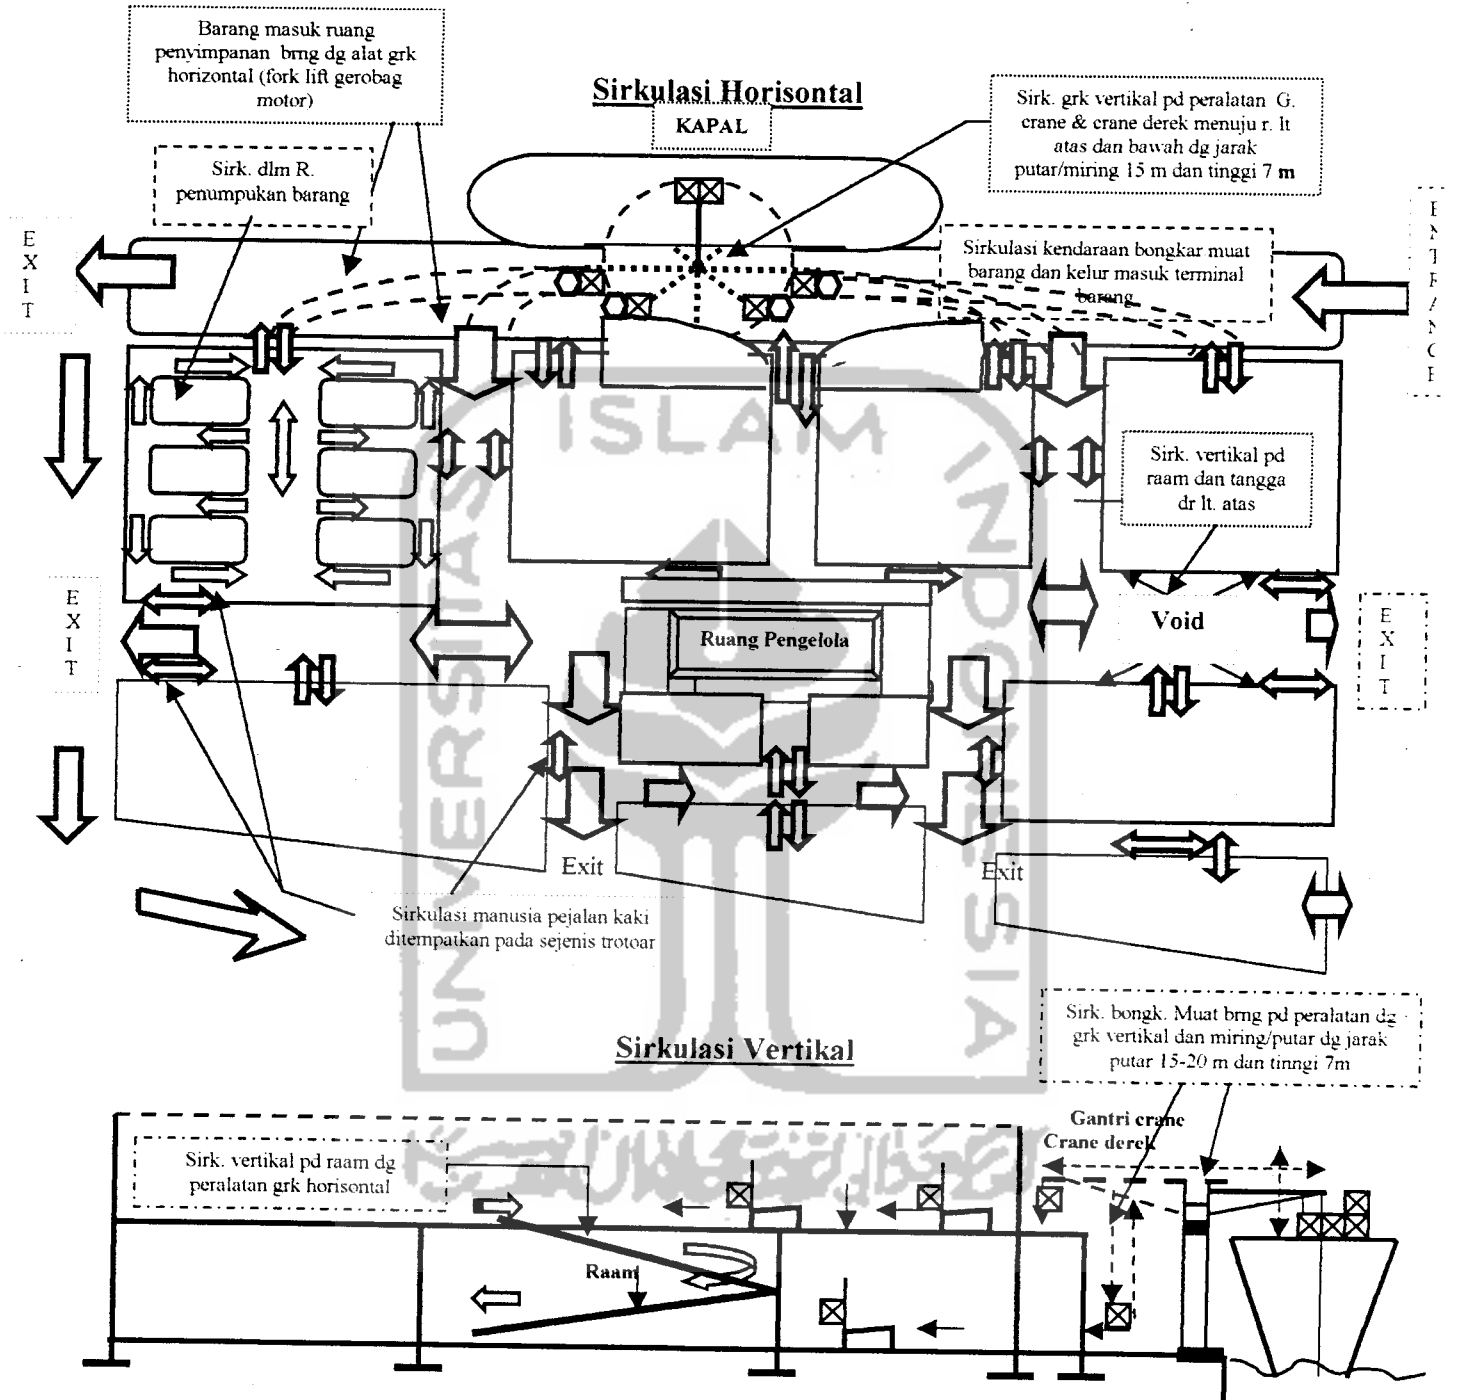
Konsep alur Sirkulasi lantai atas
